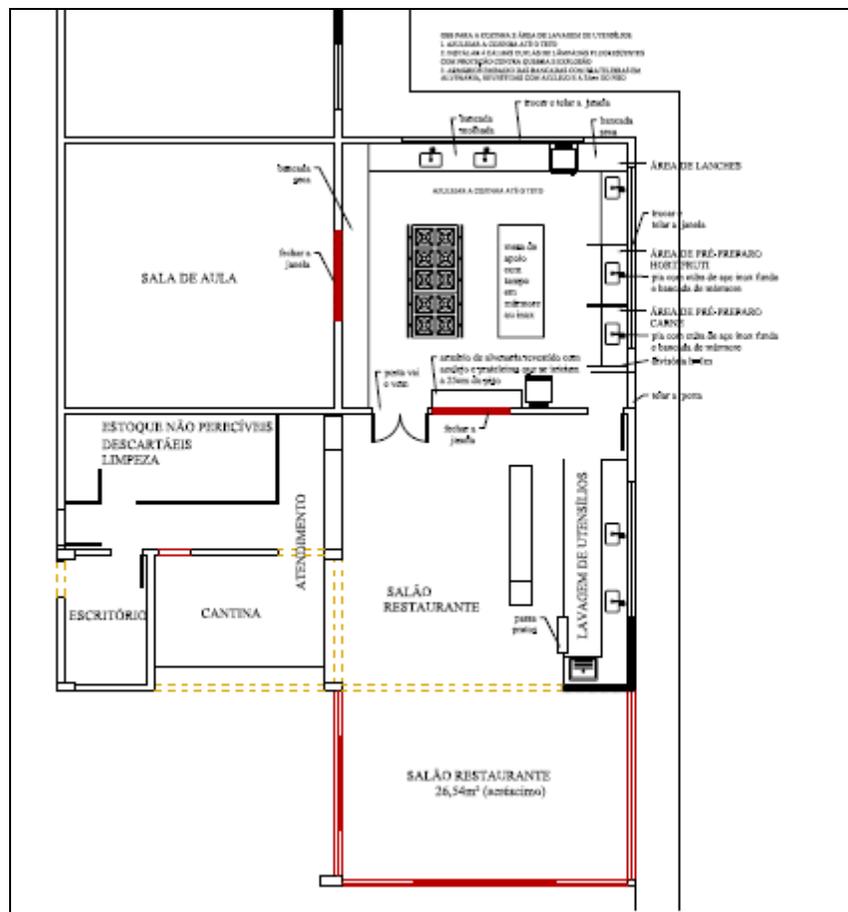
Planta baixa proposta para a reestruturação da Unidade de Alimentação e Nutrição.
